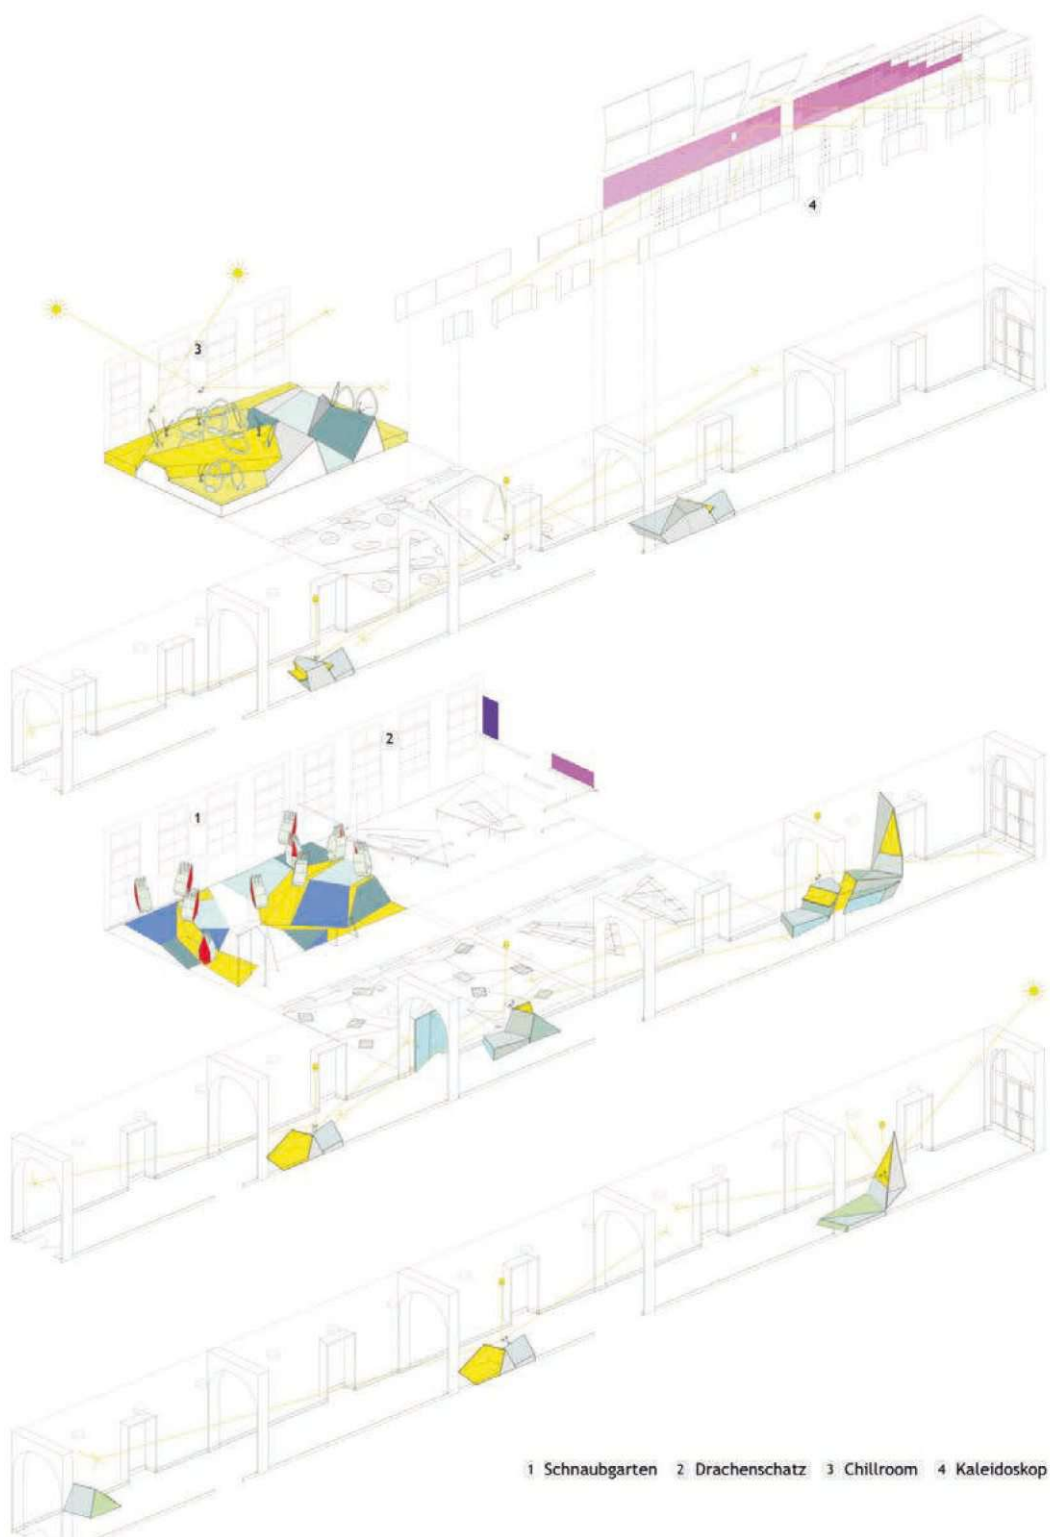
Erika-Mann-Grundschule, Umbaumaßnahmen im 2. Bauabschnitt. Modulare Sitzlandschaften. Baupiloten
